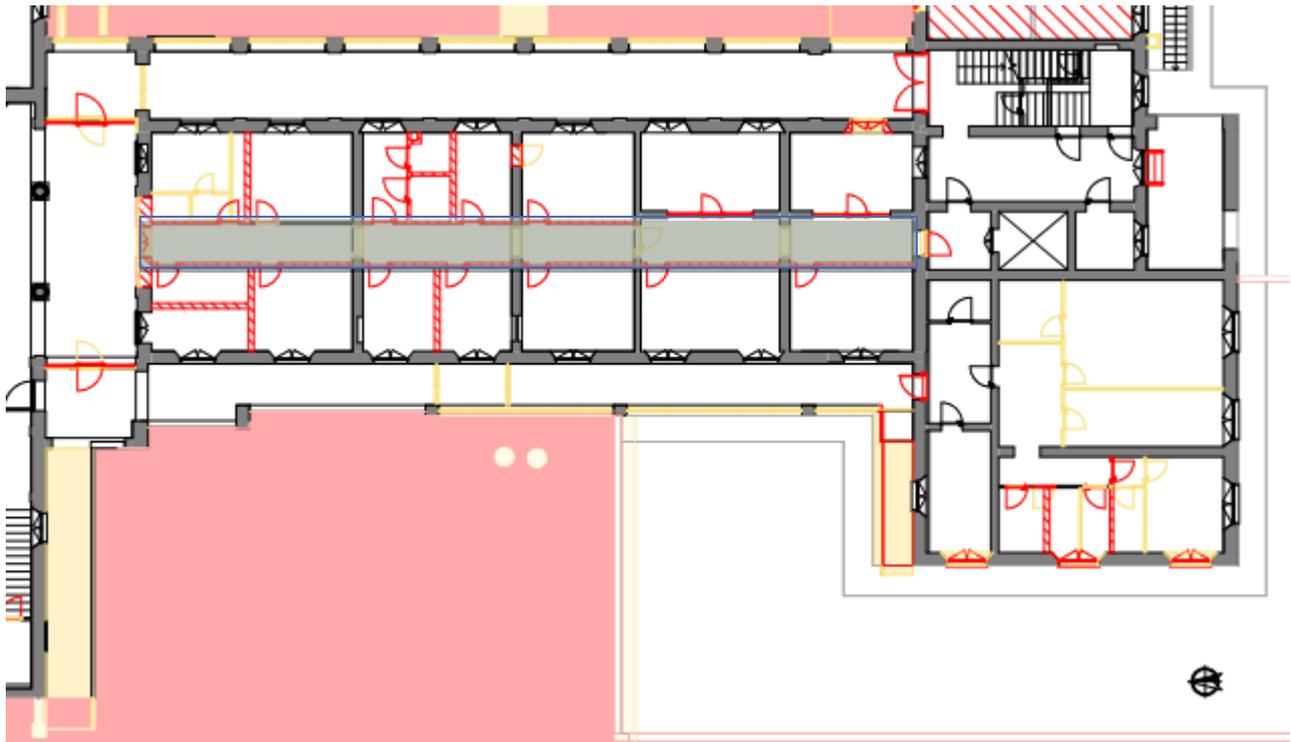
Interventi murari previsti al piano terra (zona centrale e sud)
